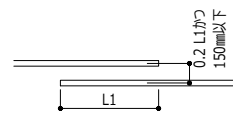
スラブ筋・基礎スラブ筋・壁筋のあき重ね継手
